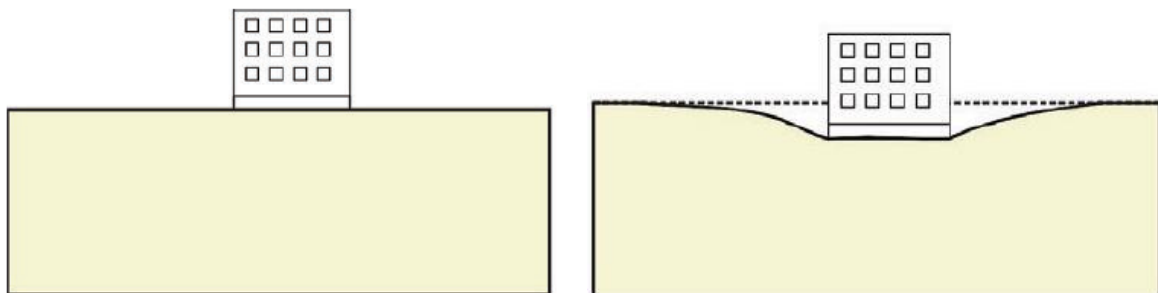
Ejemplo de subsidencia debida a la consolidación.
